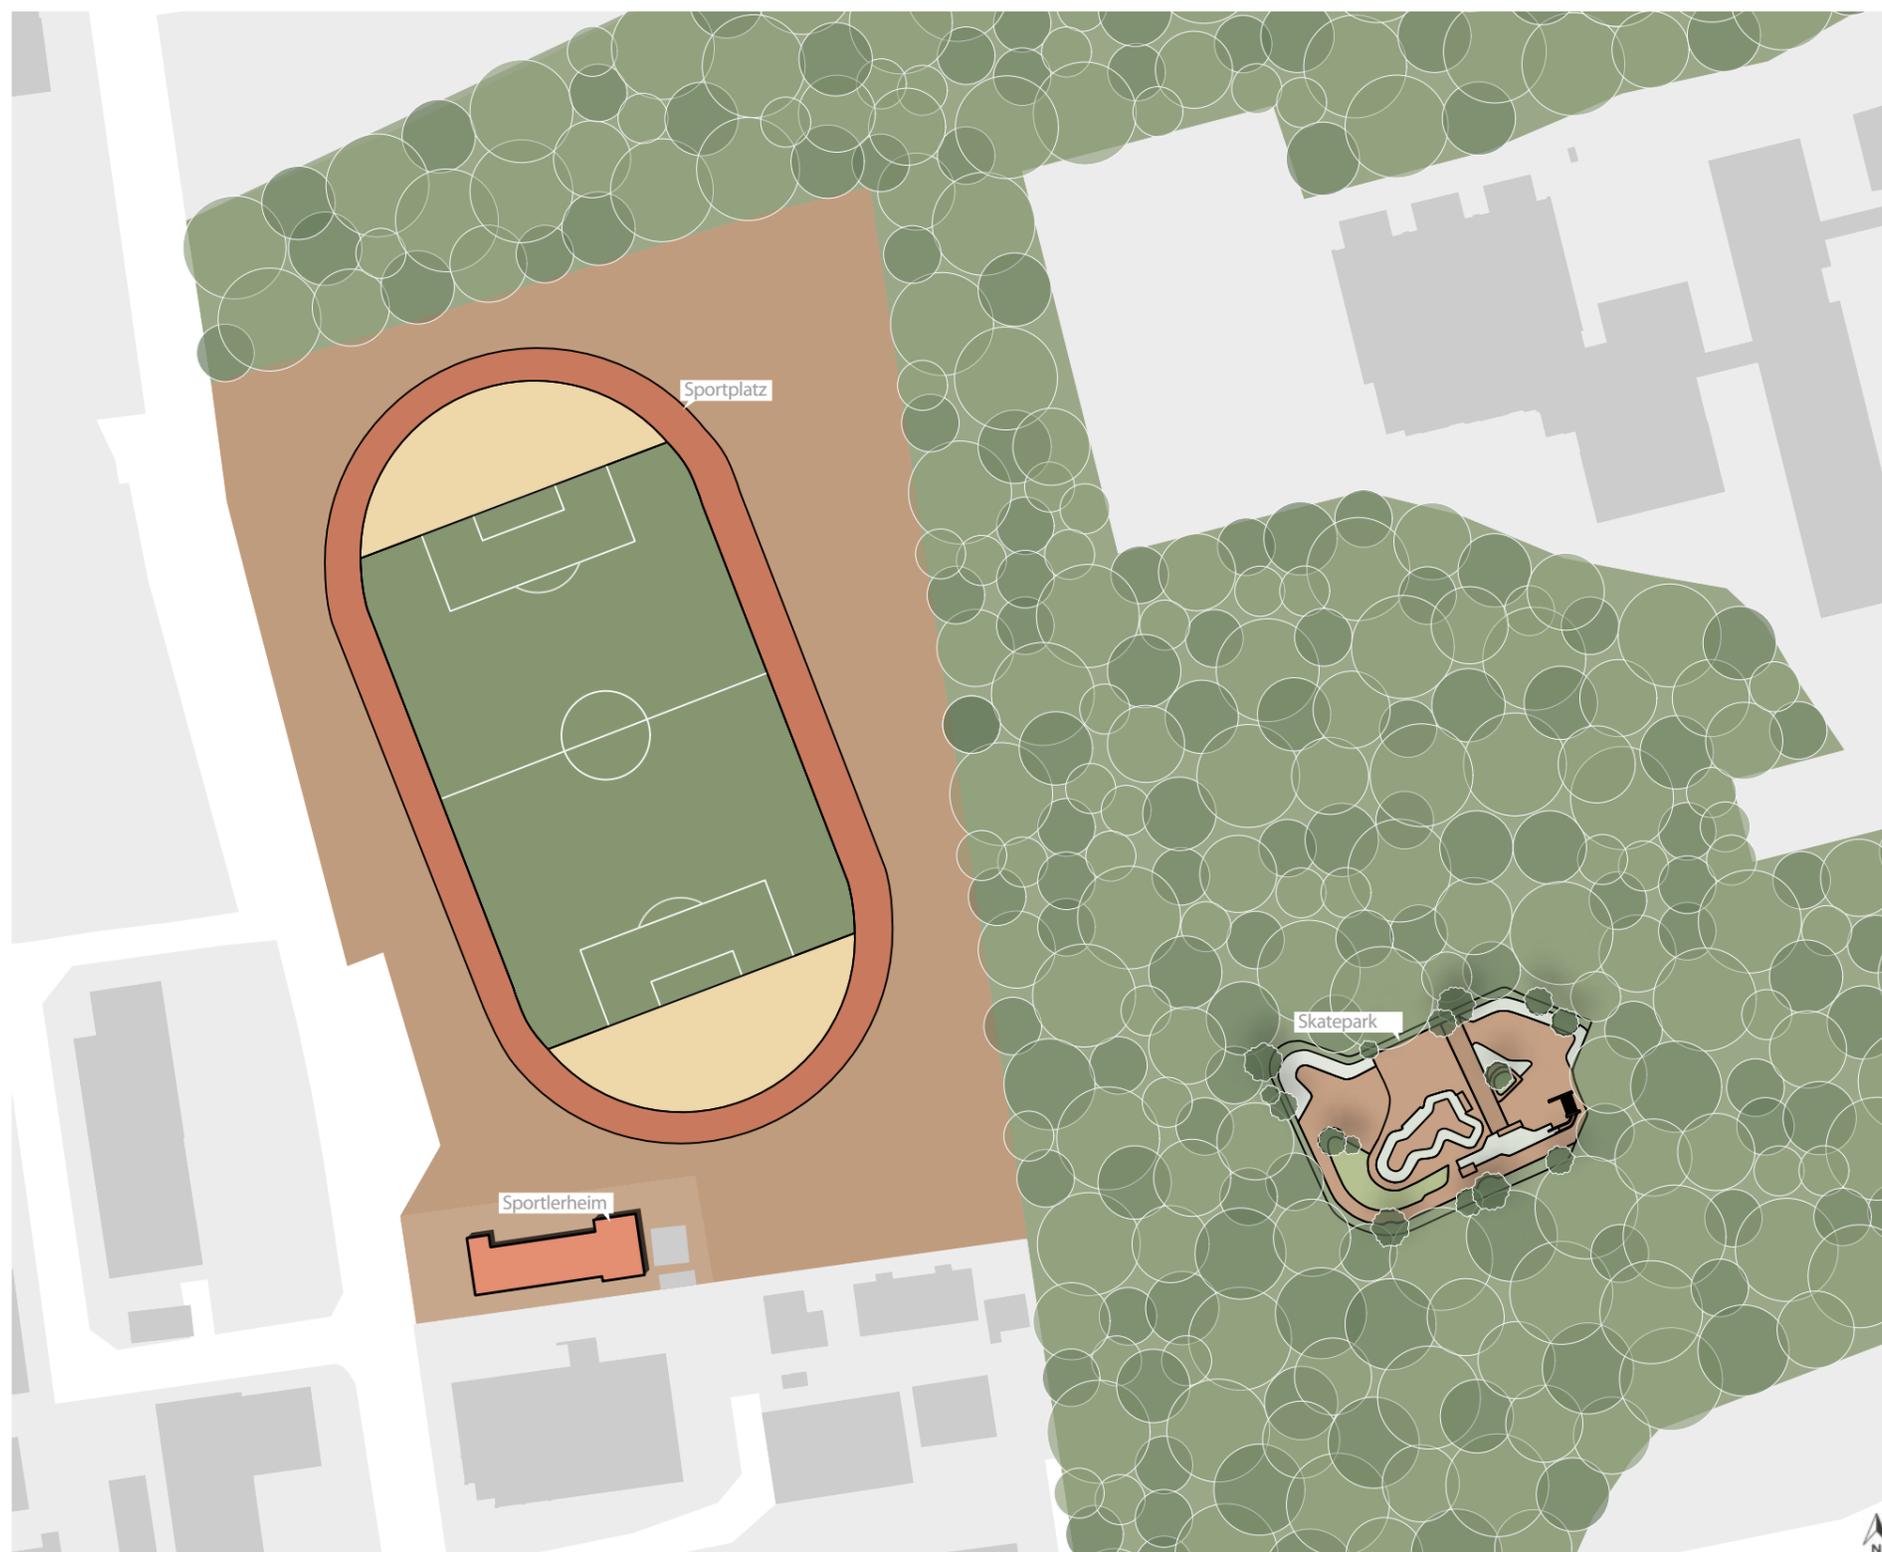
Lageplan bestehende Sportanlage und Sportlerheim mit neuem Skatepark, o.M.
